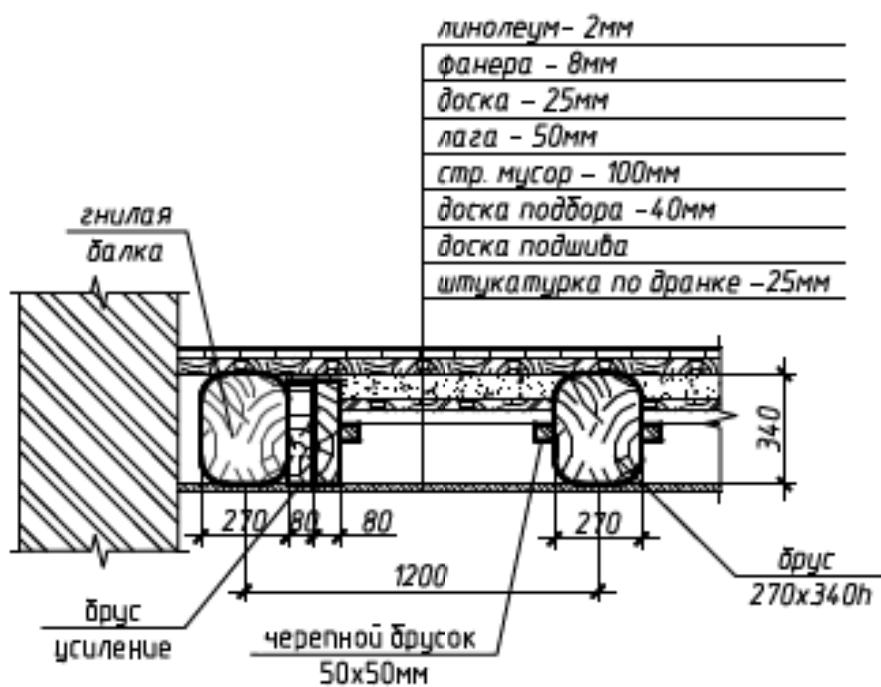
Вскрытие 8 (пол 2-й этаж)
